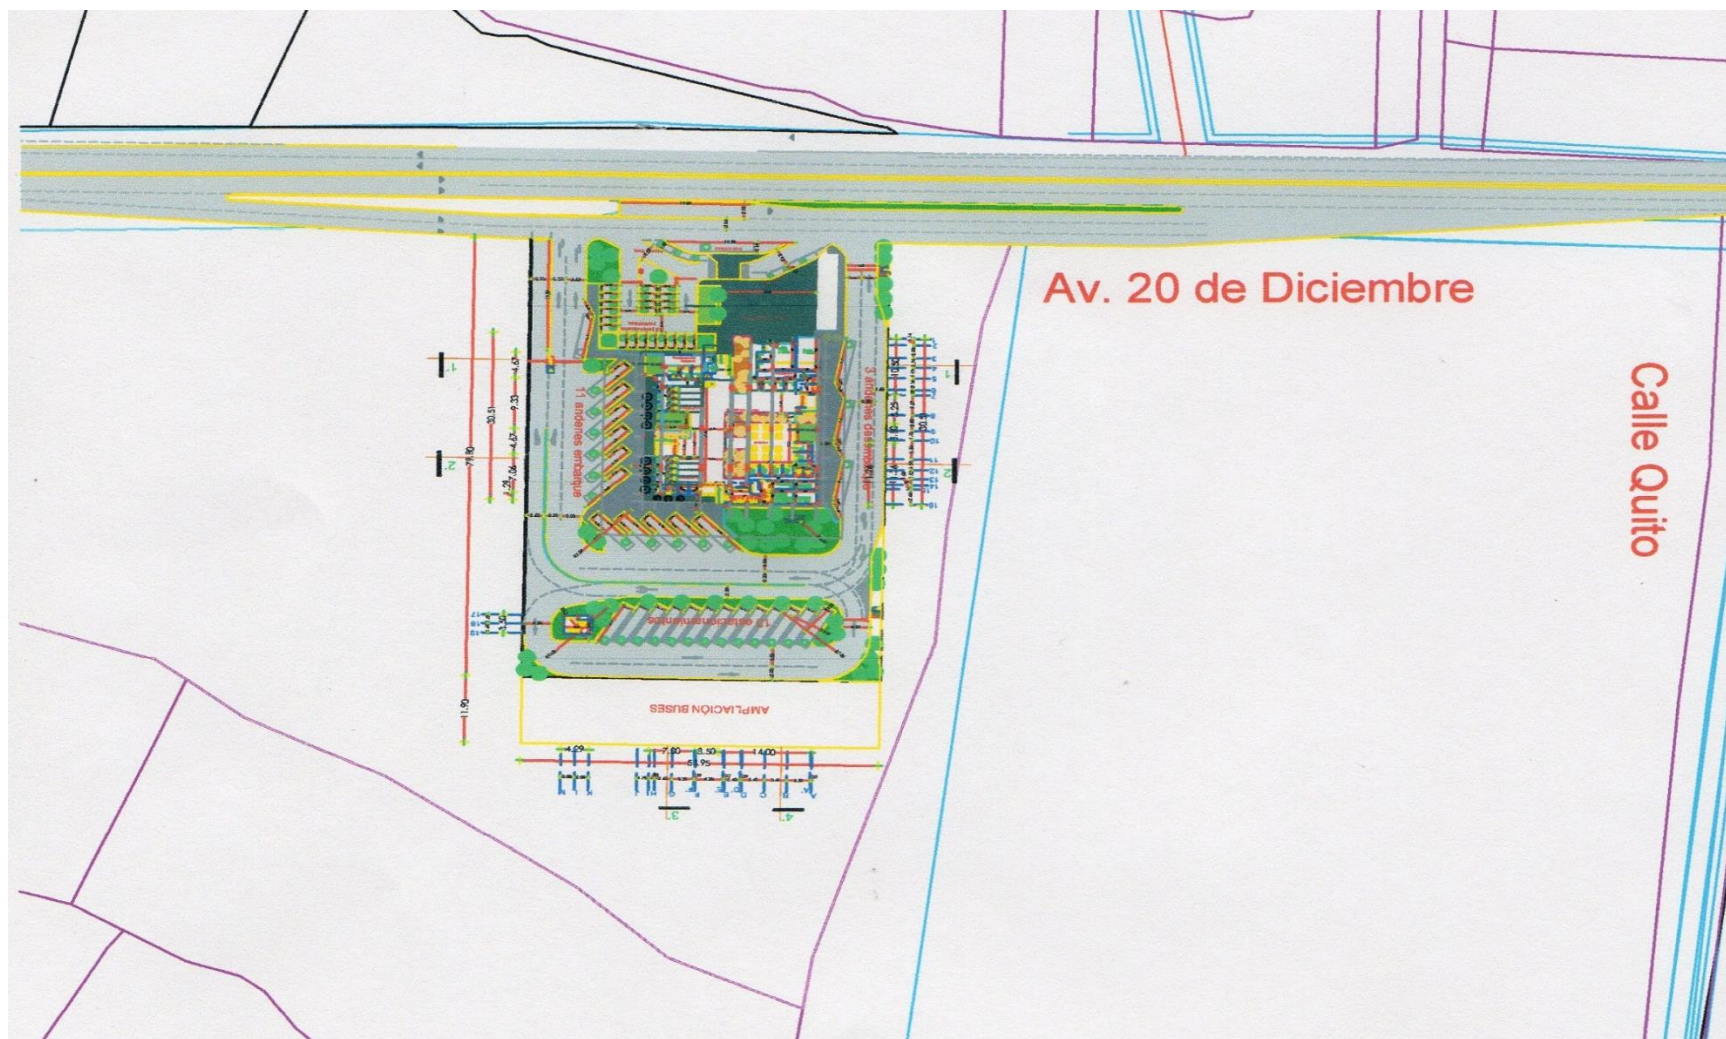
Implantación de la infraestructura de la terminal tipo 3 en el terreno elegido en Santa Teresita en el cantón Guano.
